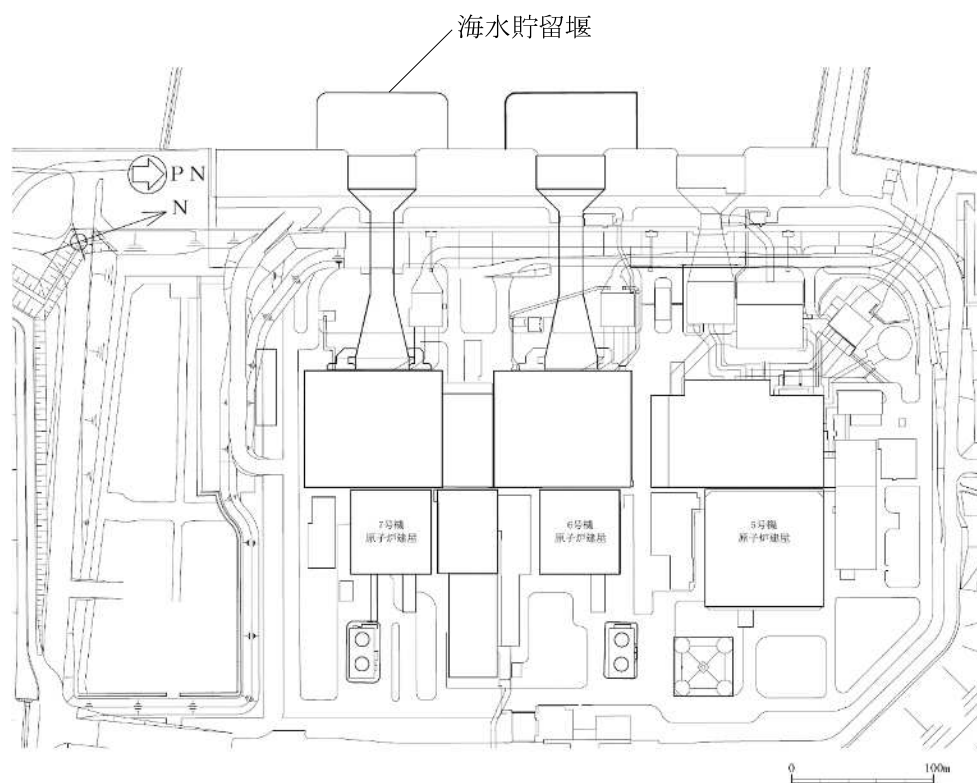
(1) 海水貯留堰の位置図（全体平面図）
